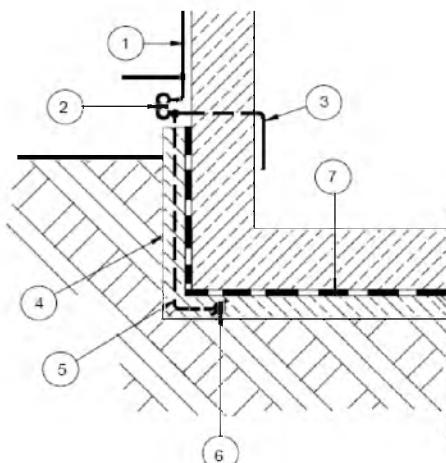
а – Изолированный фундамент с заземляющим электродом в фундаменте в неармированном бетонном слое под битумной изоляцией
